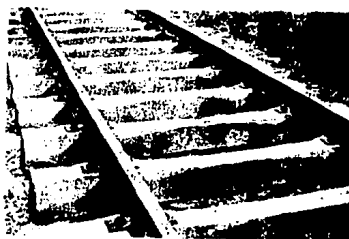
Durmiente de una sola pieza construido con concreto pretensado.
